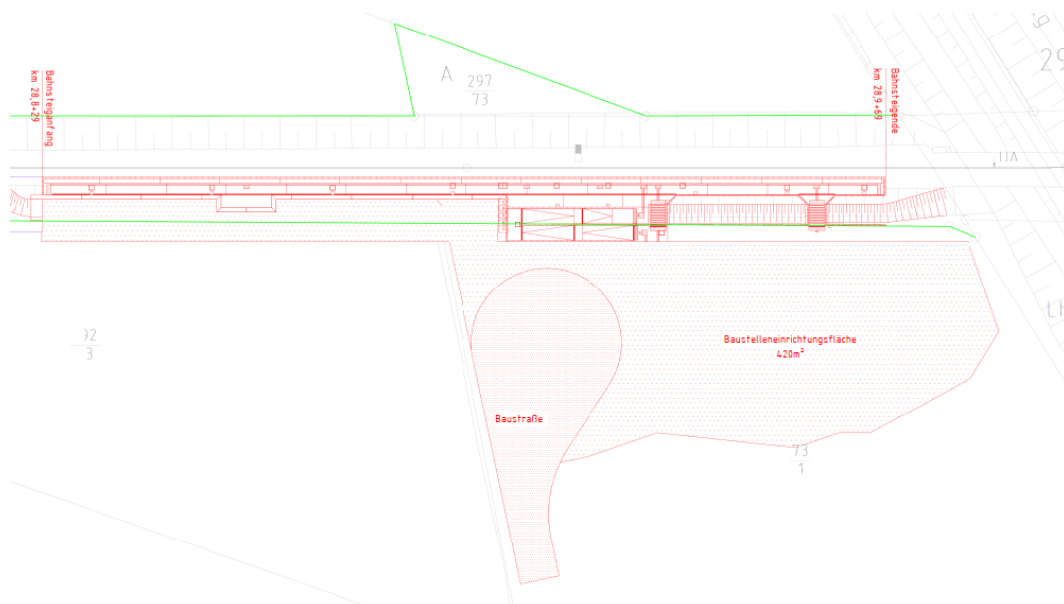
Verortung der Baustraße und BE-Fläche (Anlage 8.1.2: Baustelleneinrichtung)
